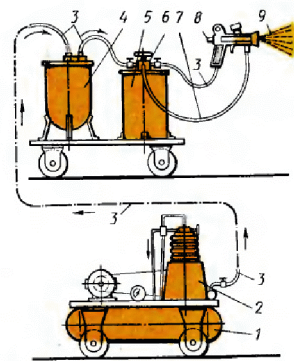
Компрессорный агрегат для нанесения грунтовки:
